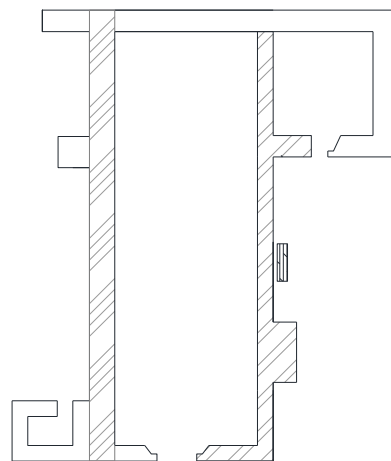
muros de mampostería. Capilla de Tecapulco, Santa María de La luz. Autor JOBG, Año. 2017
